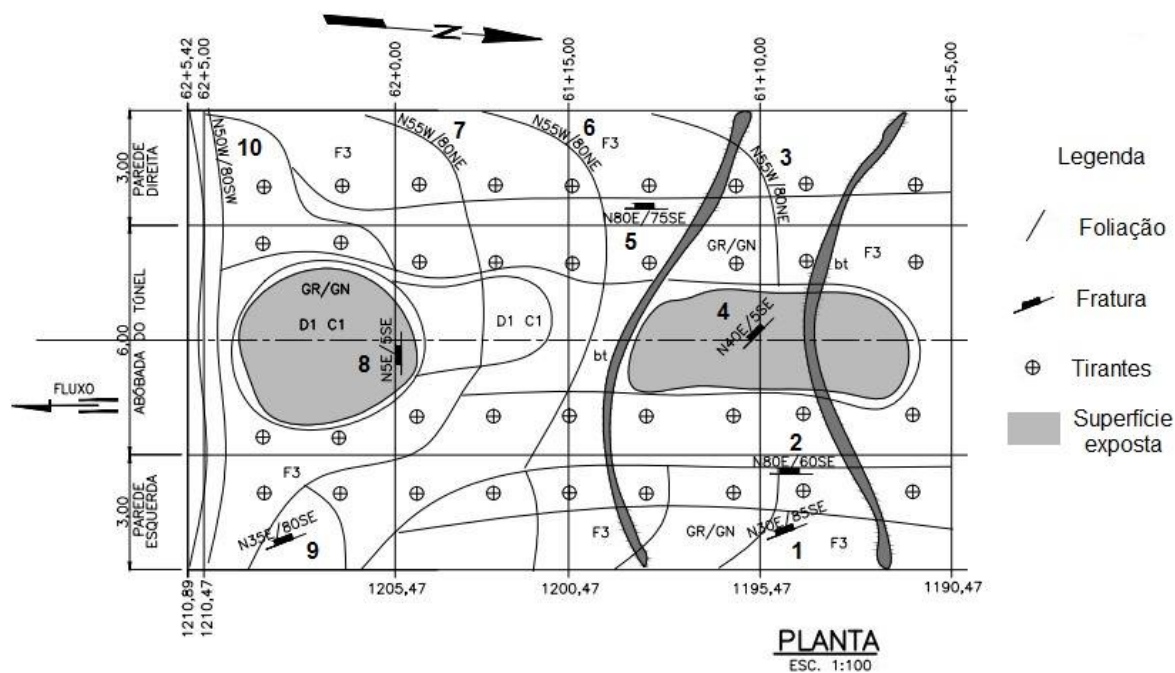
Vista em planta do croqui do desemboque do túnel de adução, na escala 1:100.
